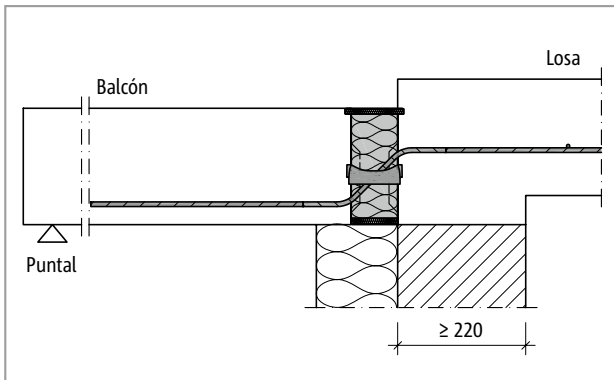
Schöck Isokorb® T tipo Q: Situación de montaje con ligero desfase de altura (p. ej., T tipo Q-V6 hasta Q-V12)
